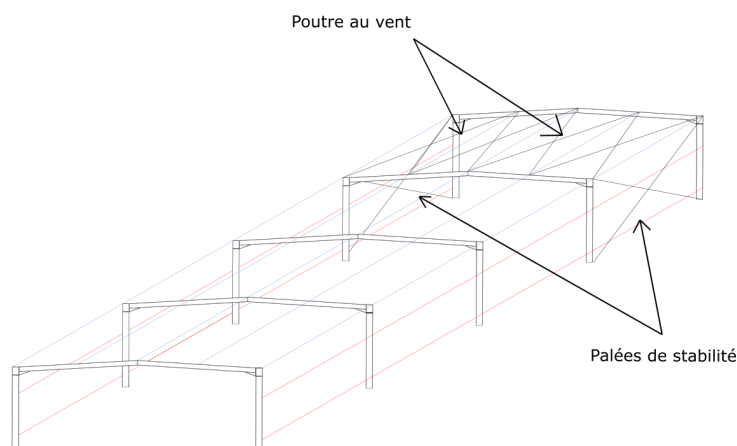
Vue en plan d'un bâtiment à base rectangulaire
